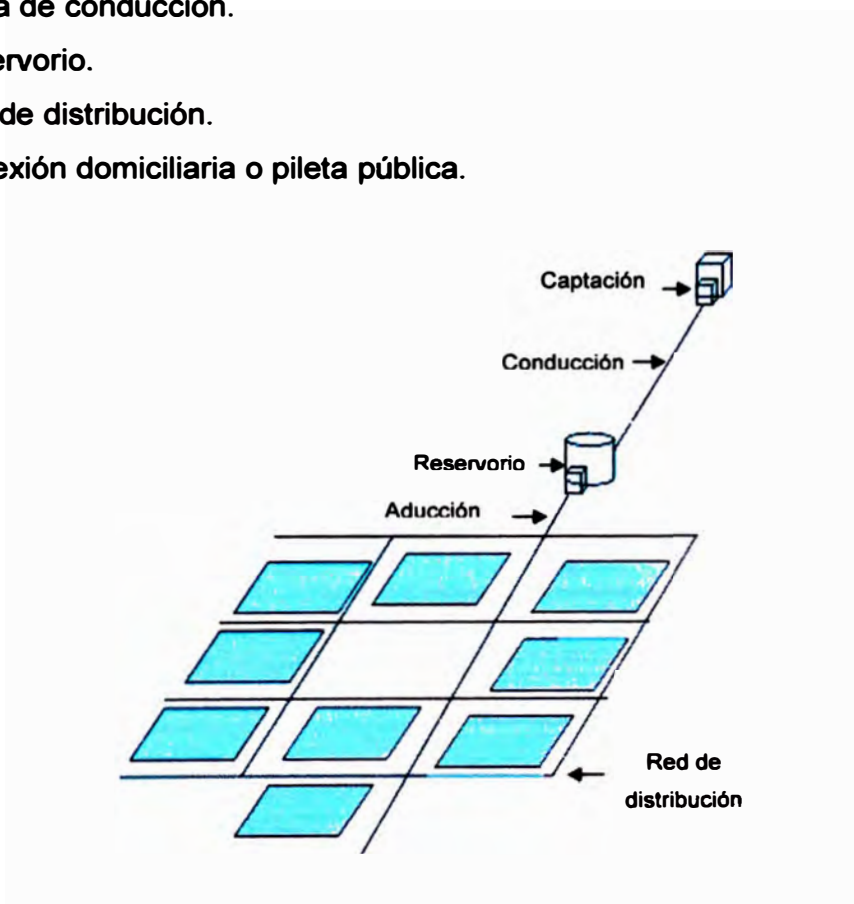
Sistema a gravedad sin planta de tratamiento
